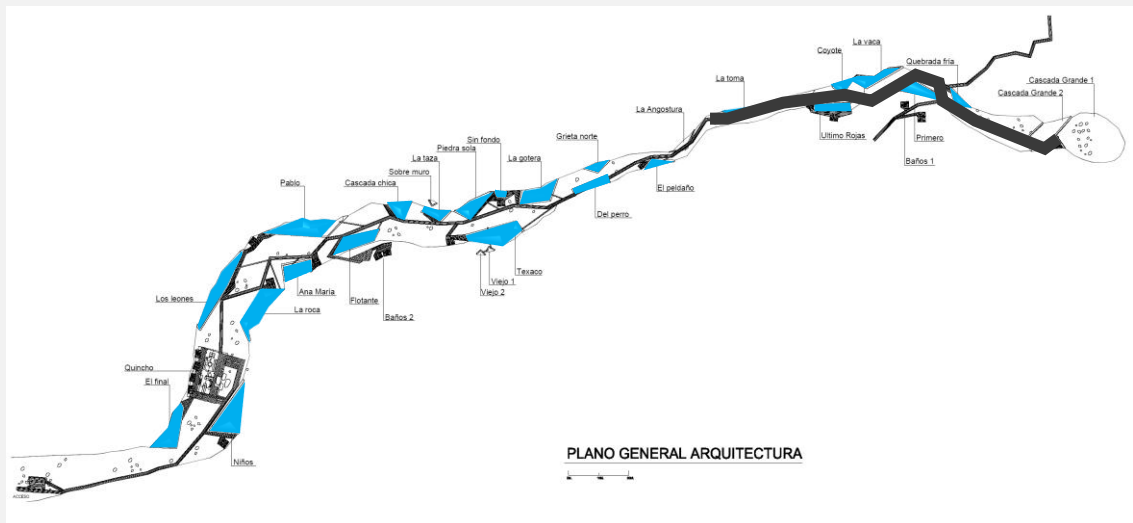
Plano General Fuente: <http://www.archdaily.co>
